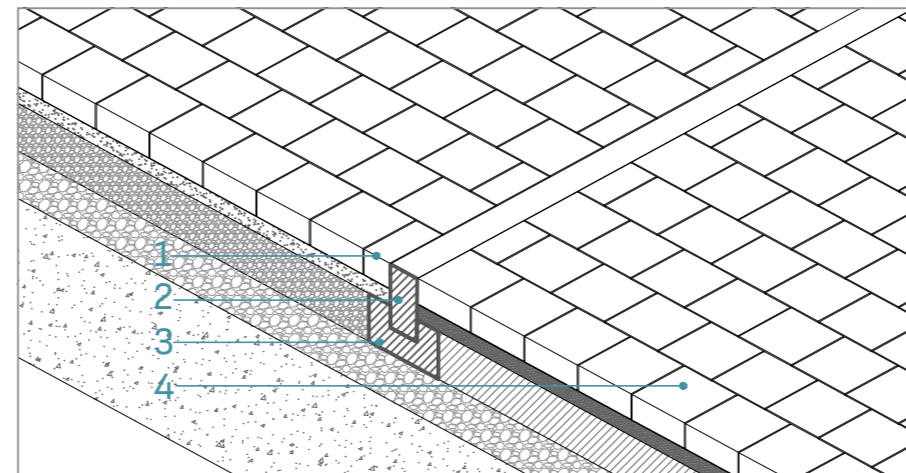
Разделителна ивица с фундамент между настилка от плочи или павеа и усилена настилка от бетон
